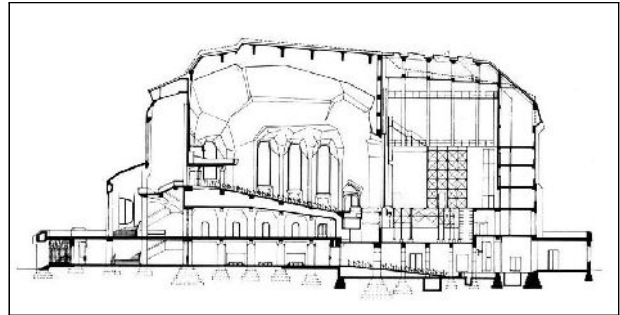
Il secondo Goetheanum. Sezione longitudinale.
